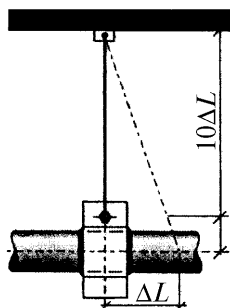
Крепление водопровода из медных труб хомутом на подвеске, учитывающей температурные перемещения
